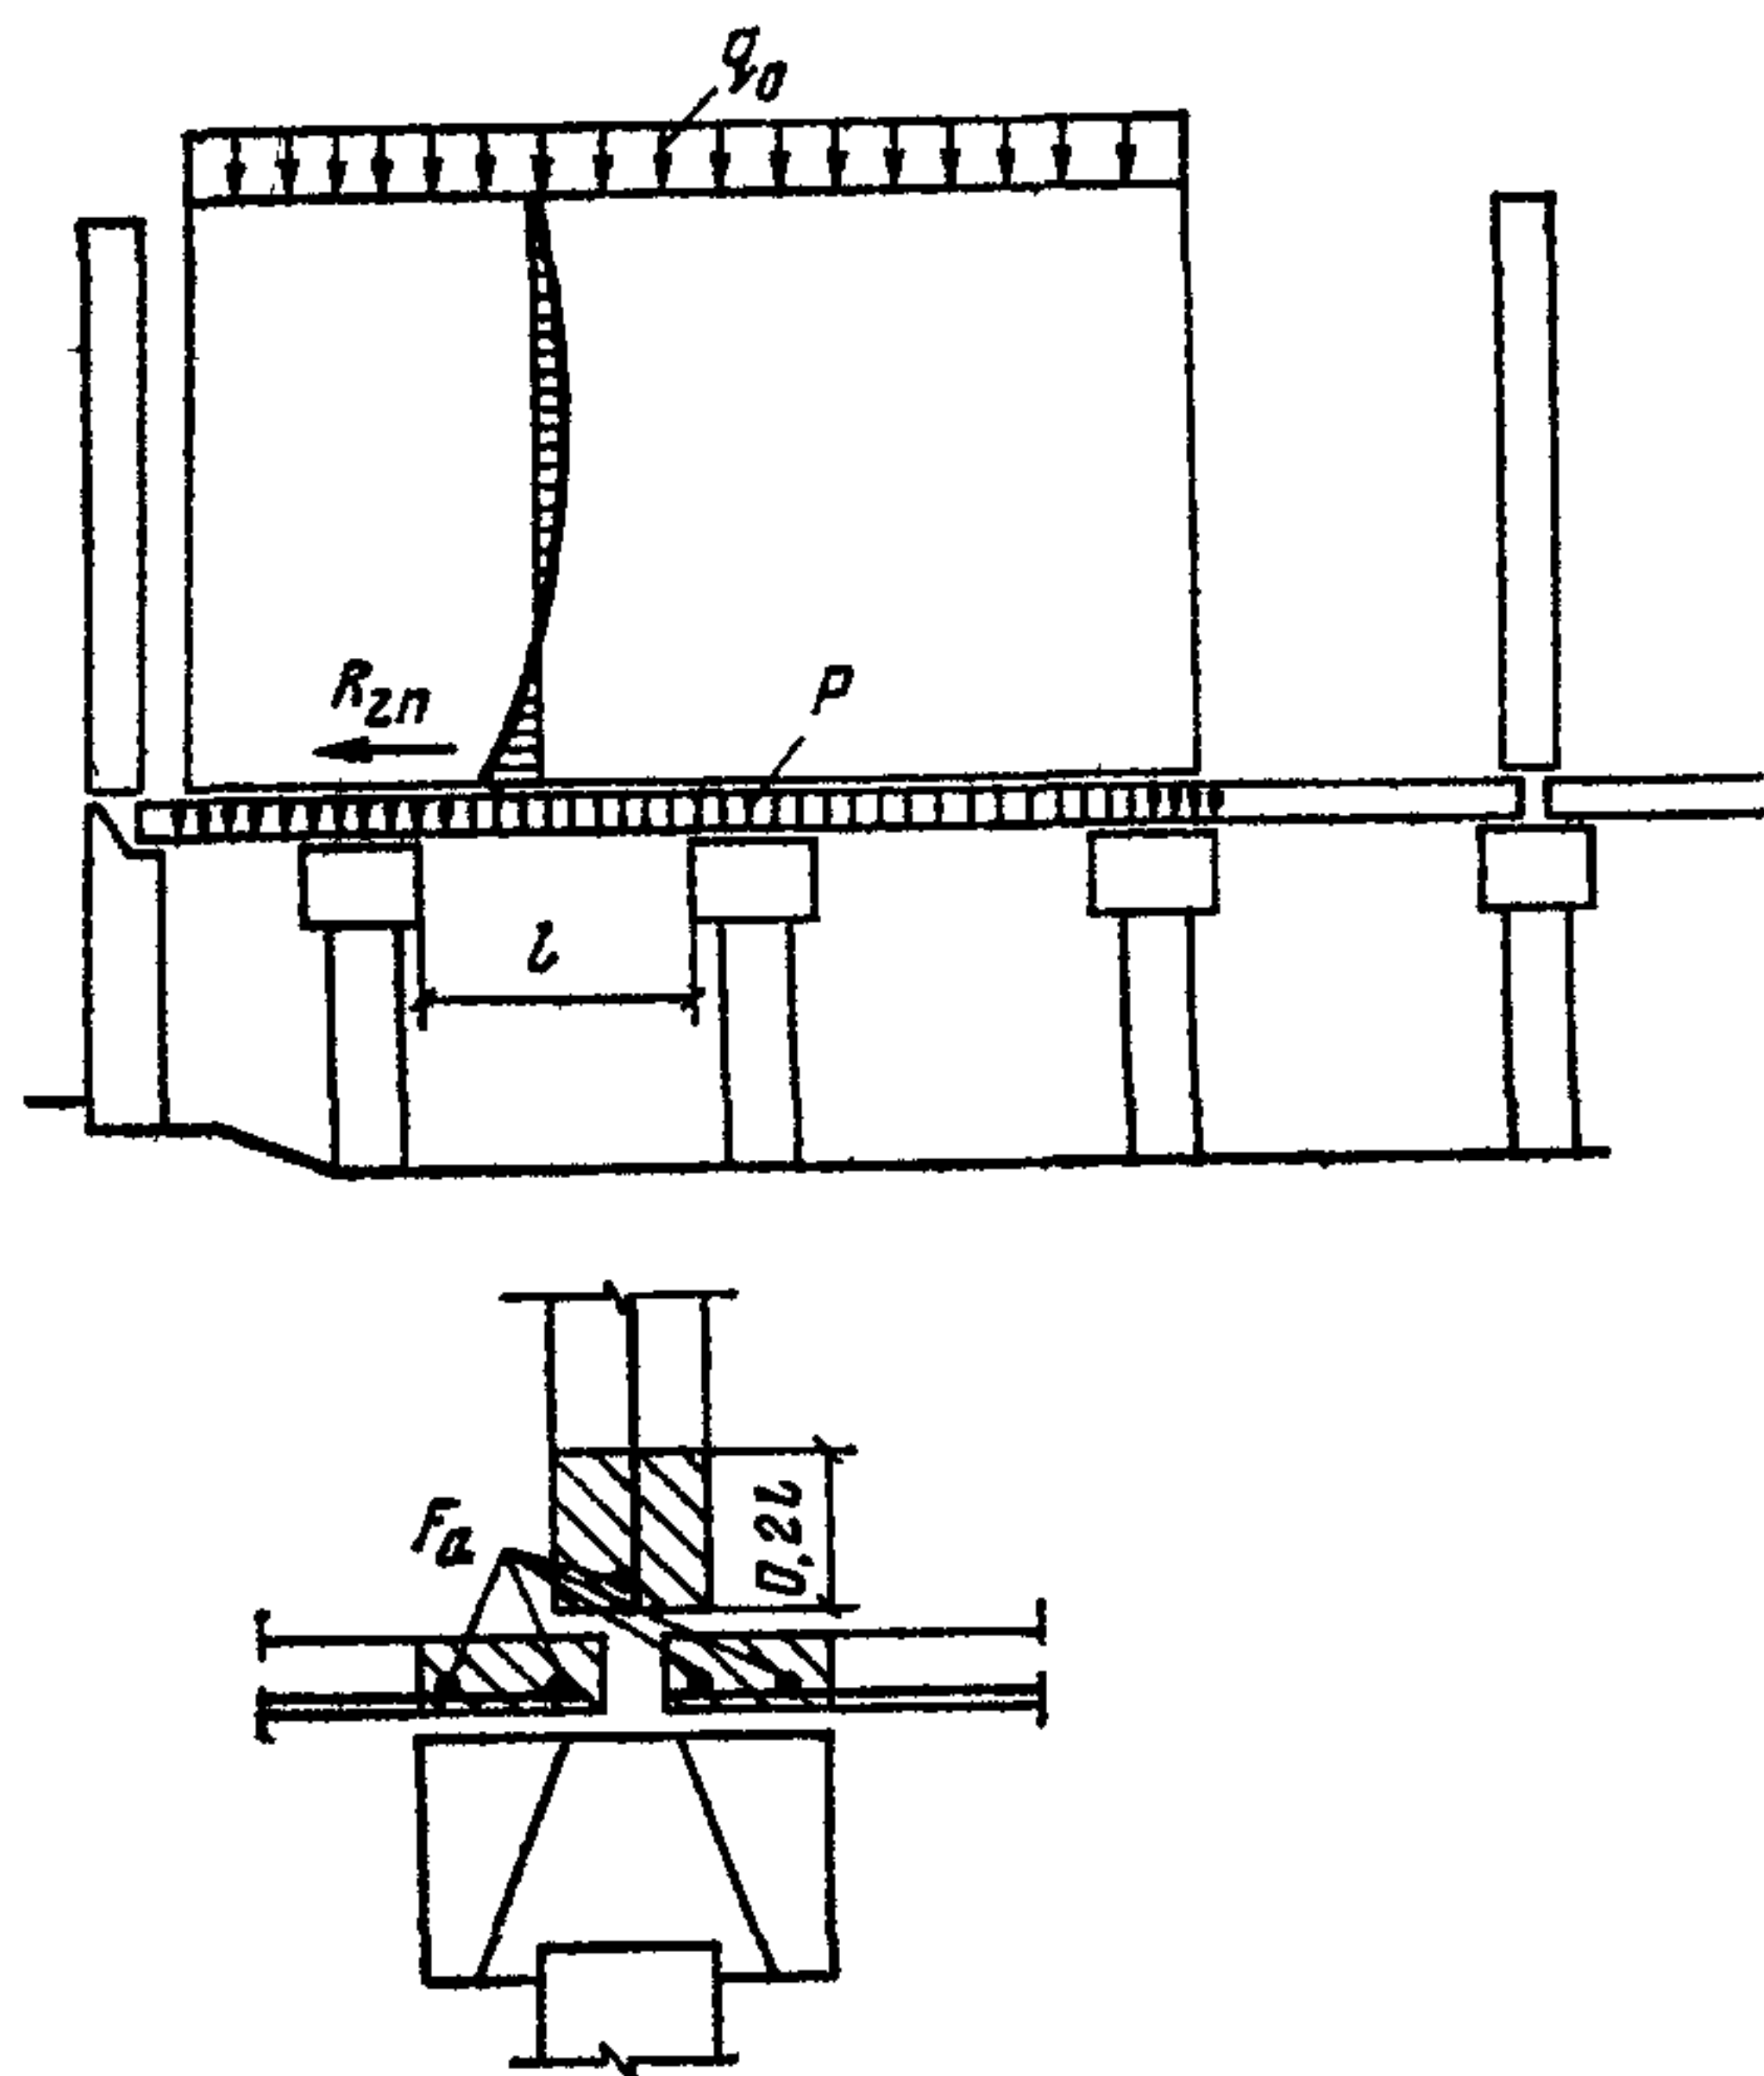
Схема расчета стеновой панели совместно с панелями перекрытий
